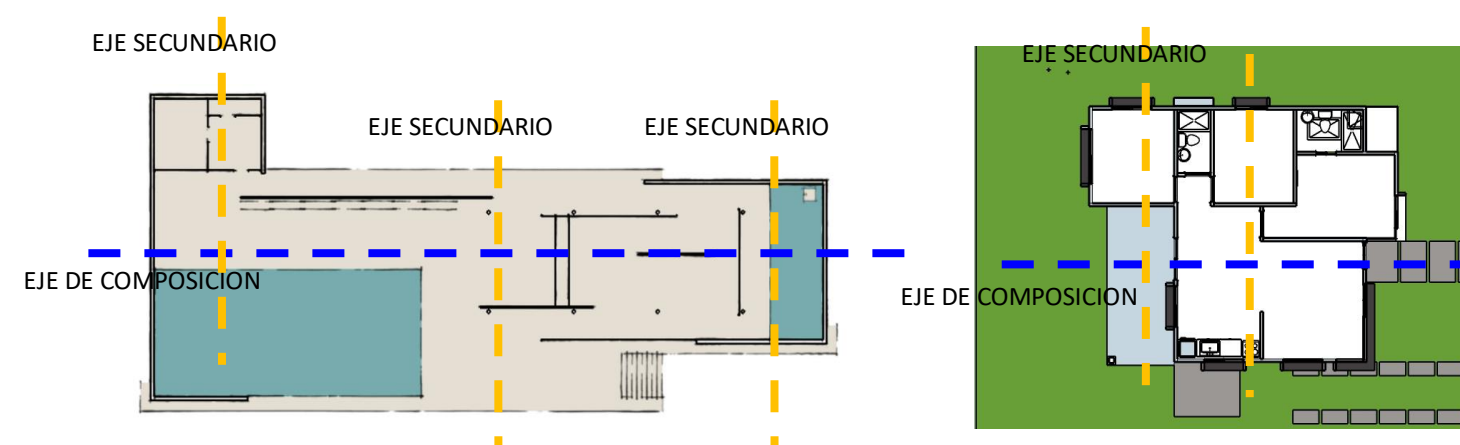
PLANTA DEL PABELLON ALEMAN EN BARCELONA DE MIES VAN DER ROHE vs PLANTA DE VIVIENDA 1
